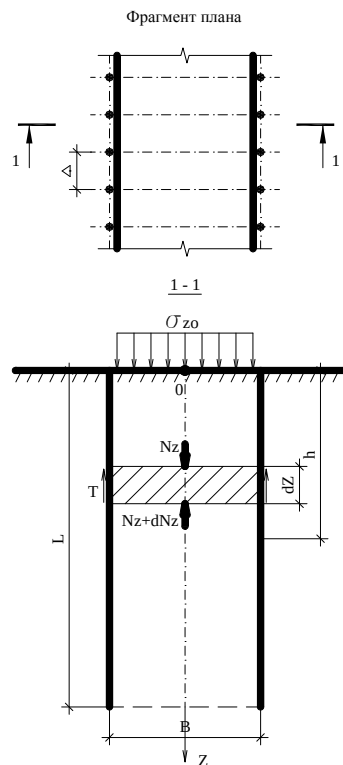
Расчетная схема контурного армирования основания ленточного фундамента
